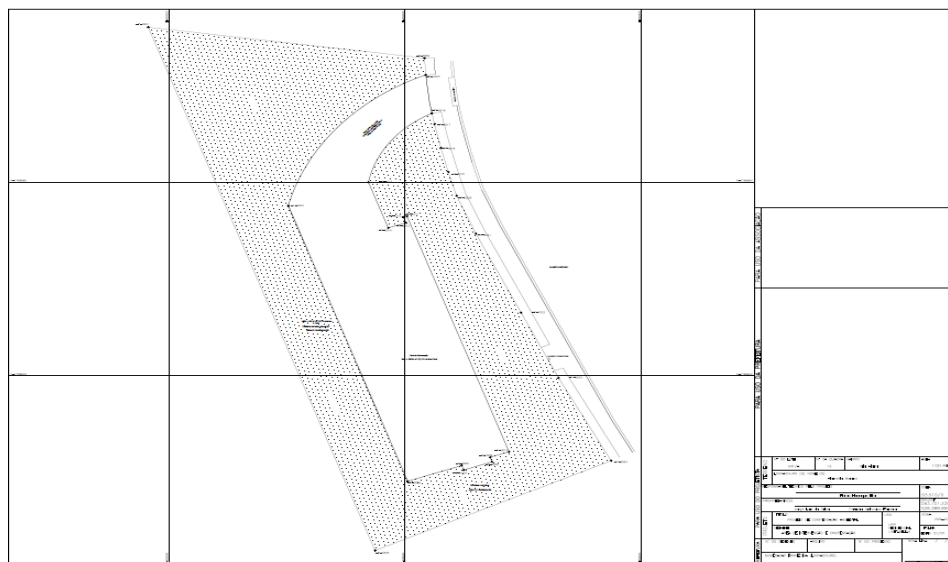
Planta ilustrando as áreas de intervenção/compensação/remanescentes.
